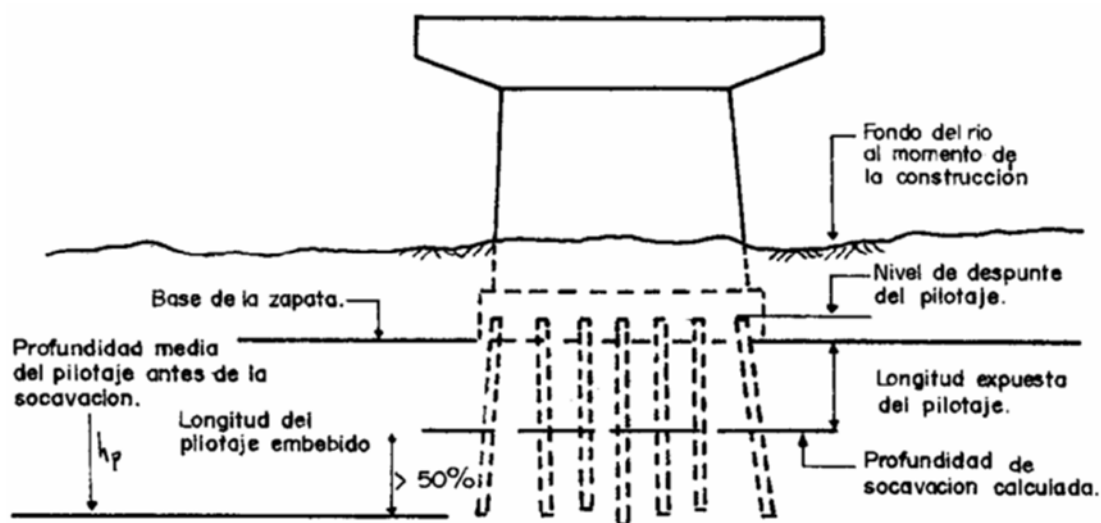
Diseño de pilotes trabajando por fricción considerando efecto de socavación. (Flemming, 1994)
